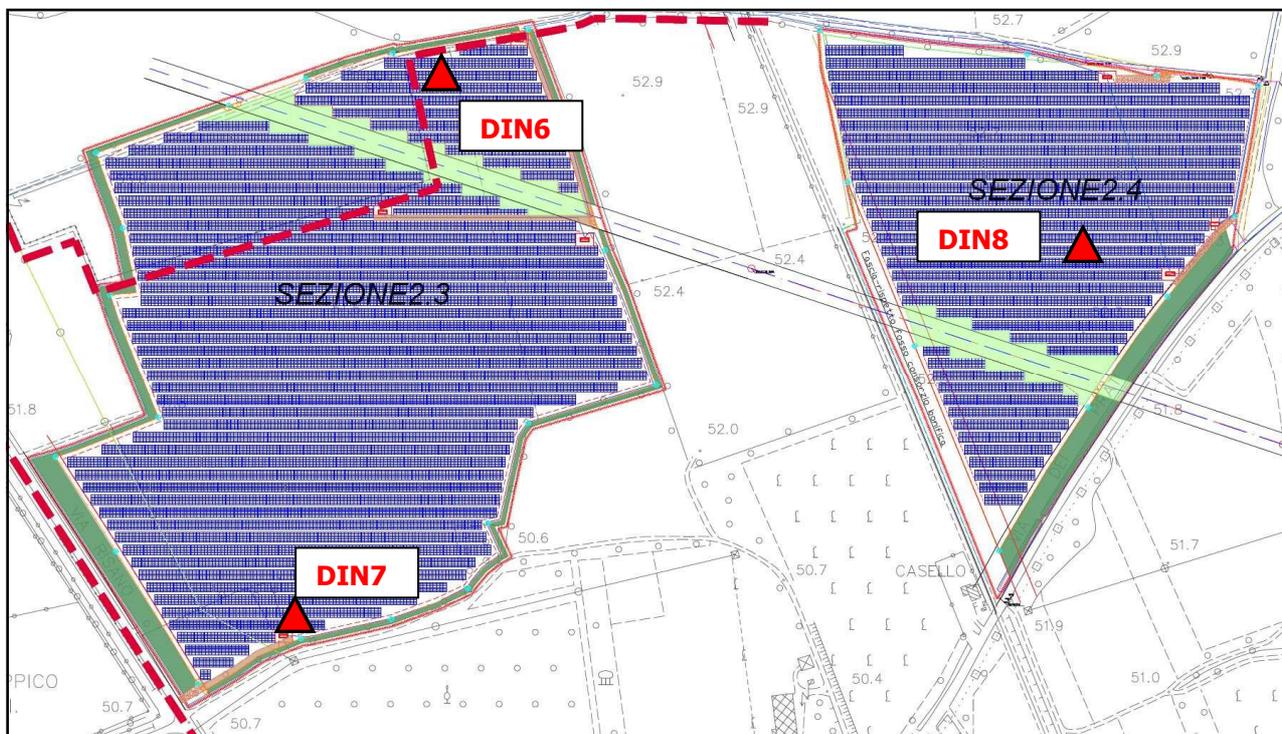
Planimetria Sezioni 2.3 – 2.4 (Non in Scala).
